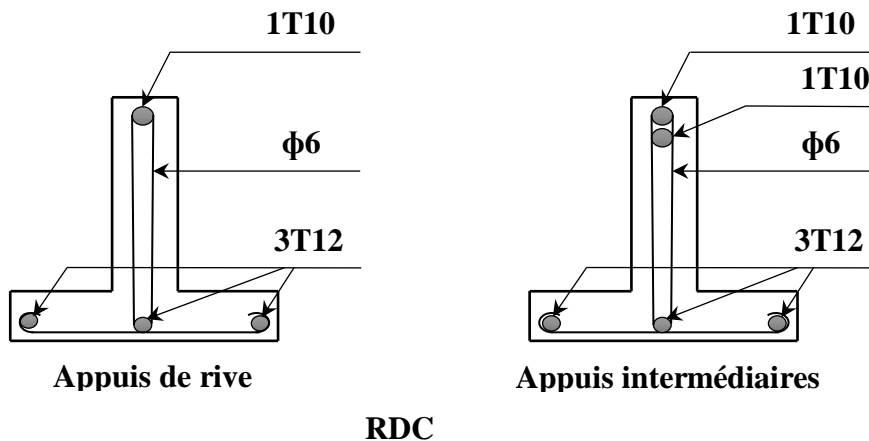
Dessin de ferrailage des poutrelles (RDC).
